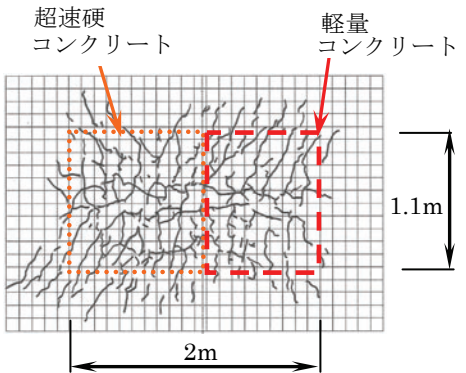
補修前の床版下面のひび割れ分布と打ち換え範囲
